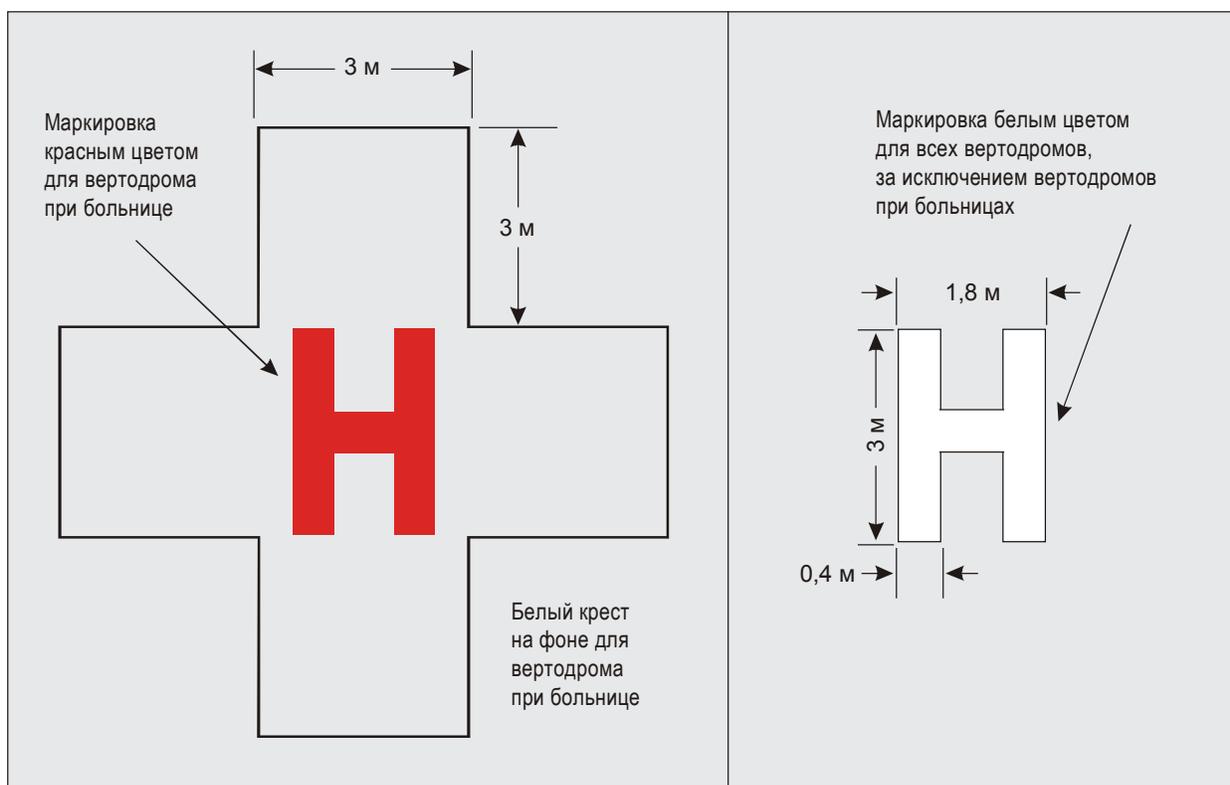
Опознавательная маркировка для вертодрома и вертодрома при больнице
